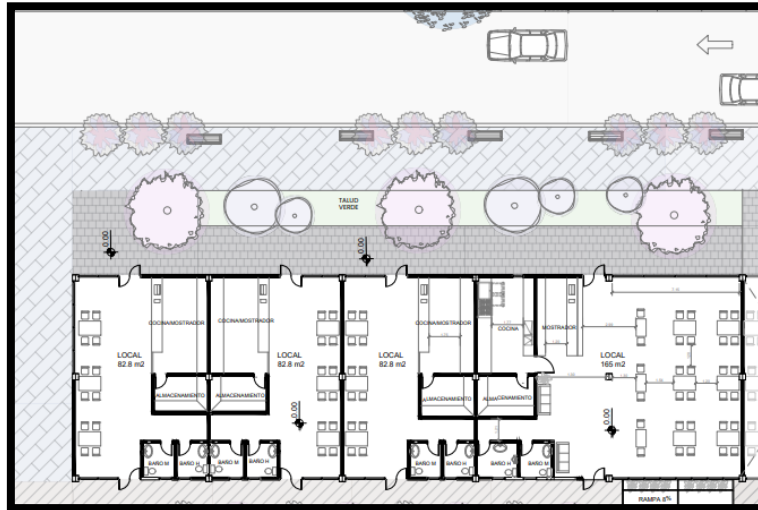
Planta Locales Nivel 0.00 Ramires S.2023
